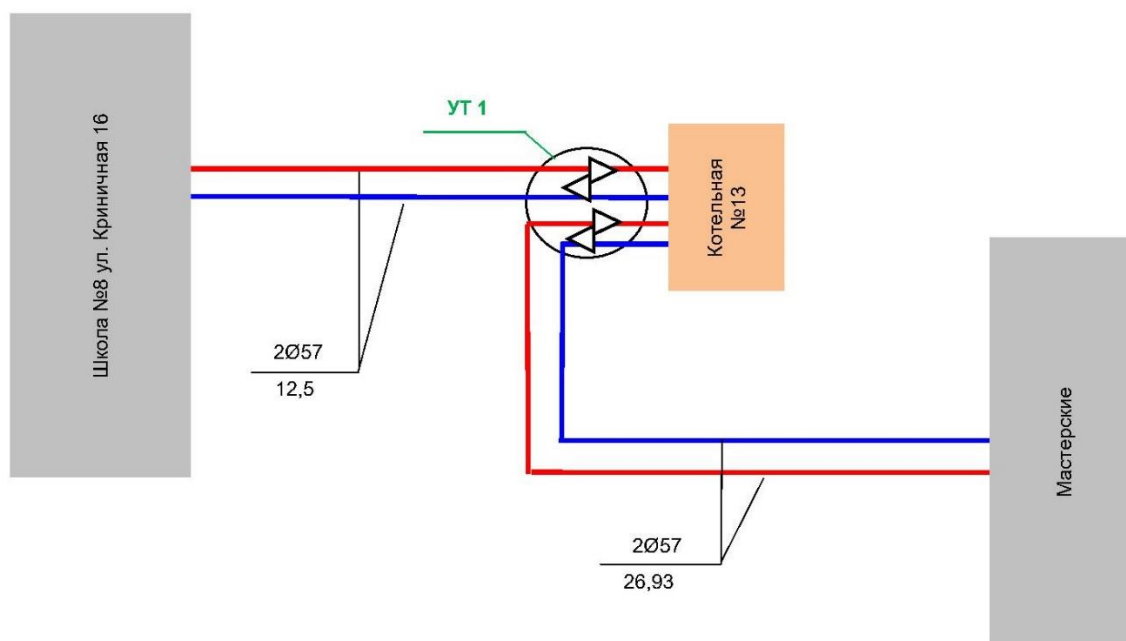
Схема тепловой сети от котельной №13 ул. Криничная, 16
